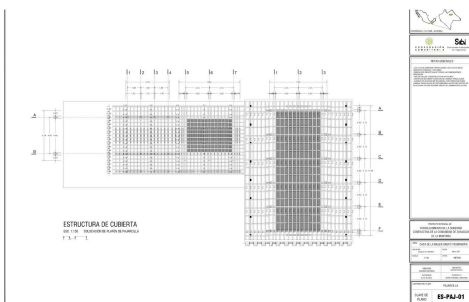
Estructura de cubierta: pajarcilla (ES-PAJ-01)
